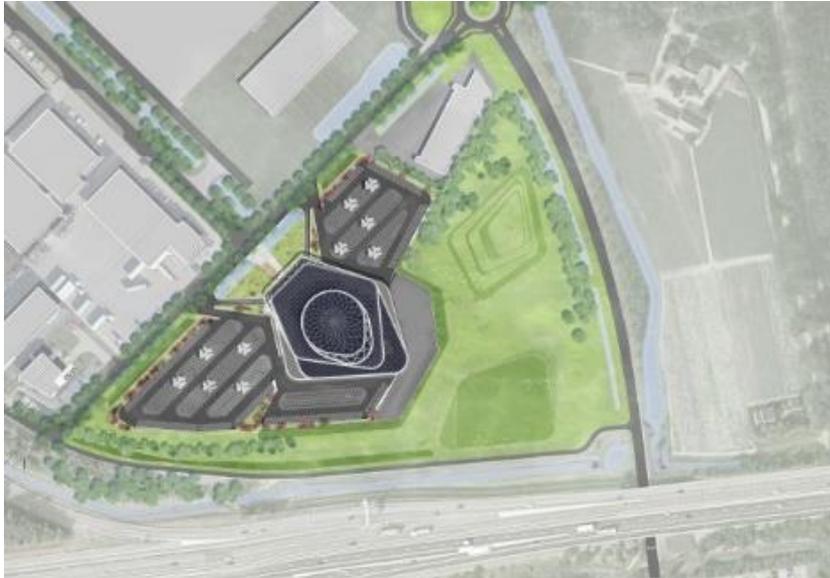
Lageplan o.M. Abbildung: MVSA_architects
